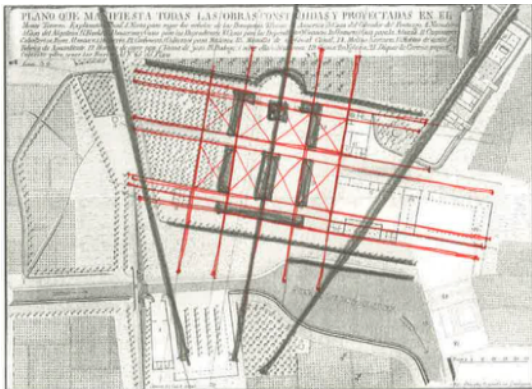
Elementos de simetría y retícula en el puerto de Miraflores.
